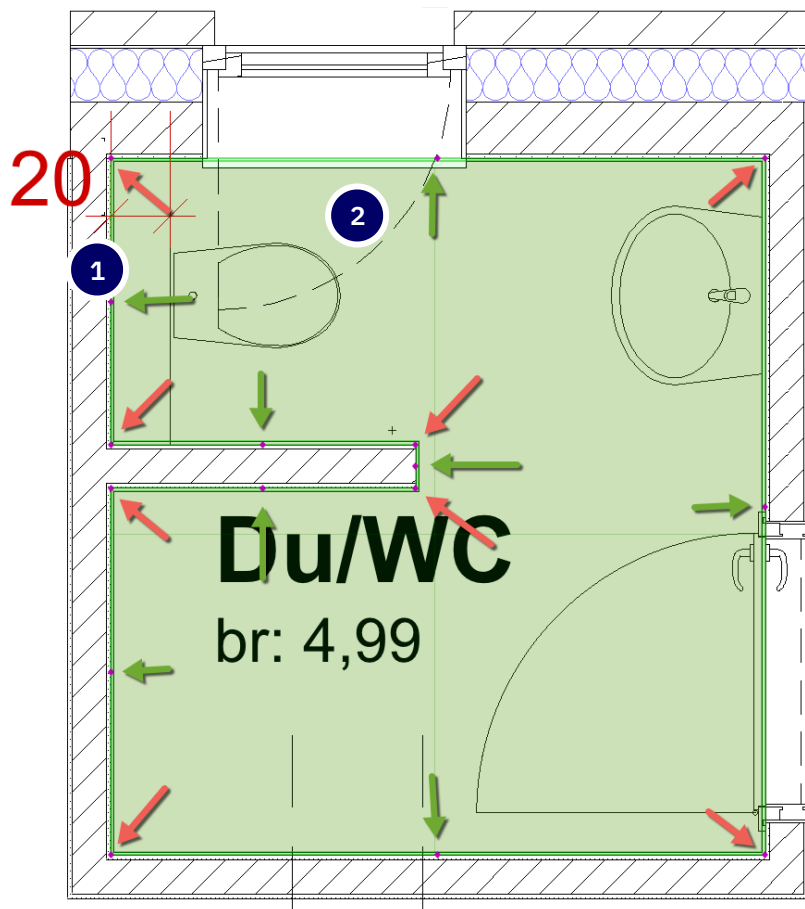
· Die beweglichen Fangpunkte des Objektes im Grundriss.
